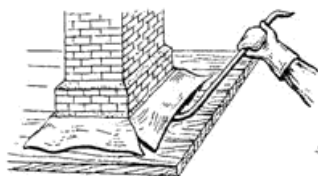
Удаление открытия из кровельного железа в примыкании кровли к дымовой
